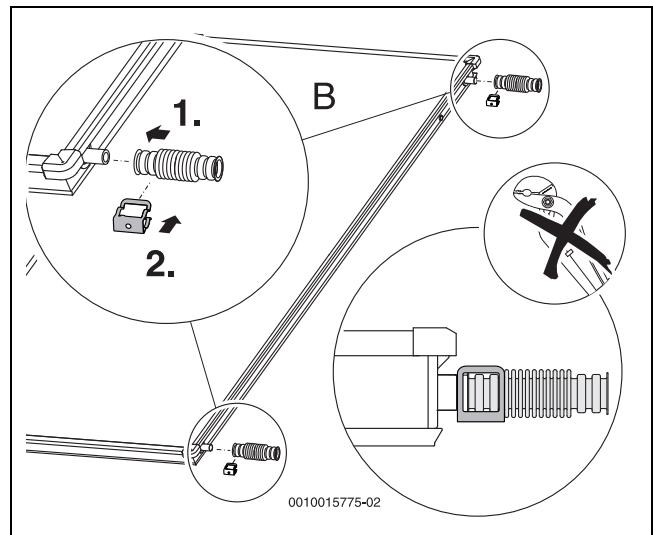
Montar el set de conexión hidráulica en el colector izquierdo
